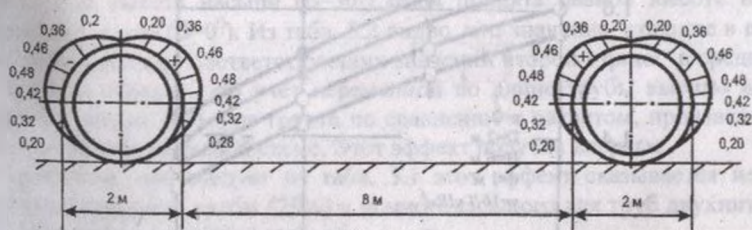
а, б. Эпюры радиального давления грунта на трубы двухниточной укладки.
